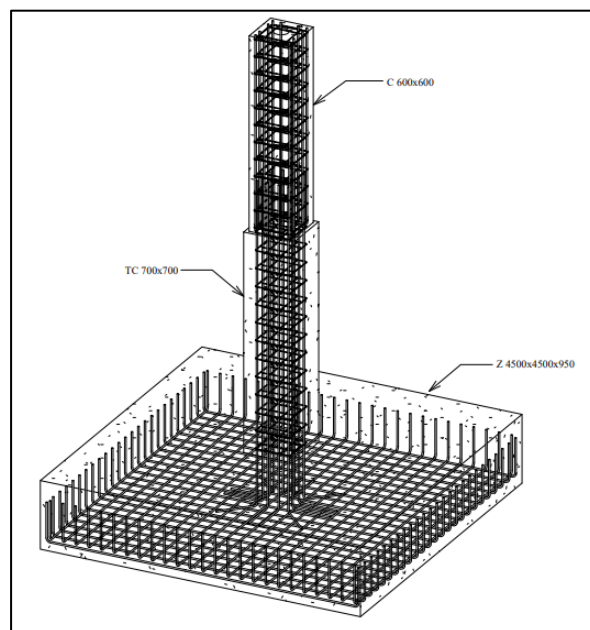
Detalle de zapata y tronco de columna. Fuente: Autor.
